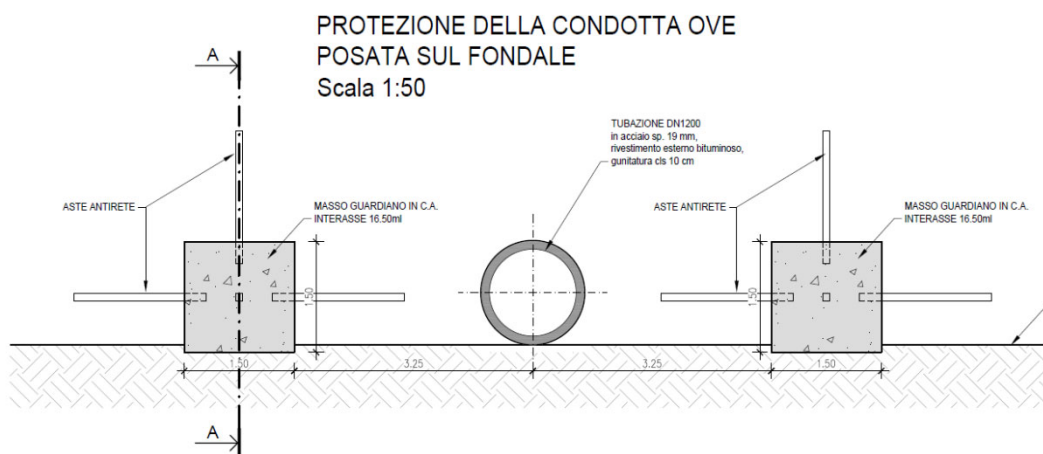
Sezione tipo di posa con condotta appoggiata al fondale.
